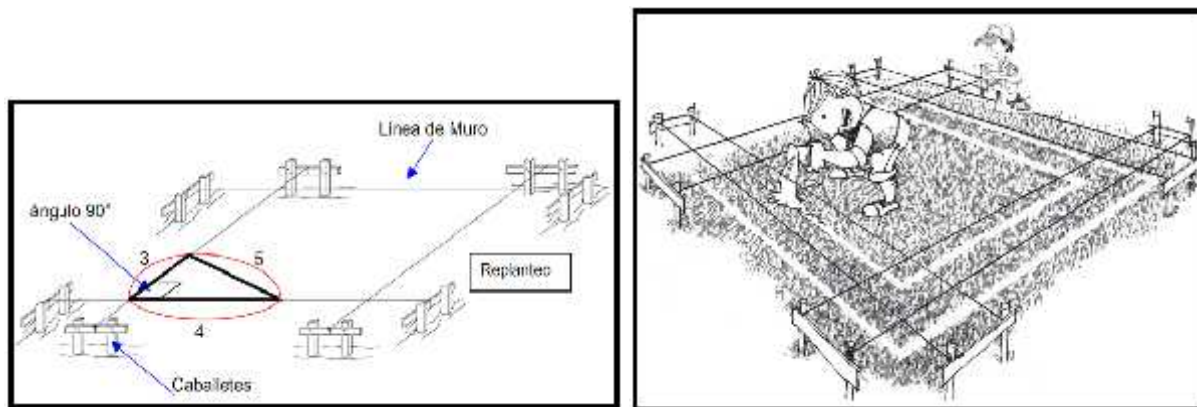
Trazo y Marcado del ancho de la cimentación.
